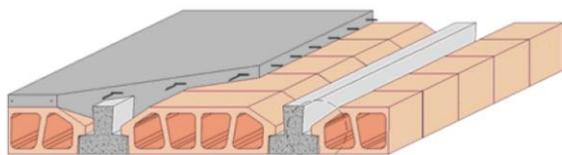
Representação esquemática de uma laje de vigotas pré-esforçadas, blocos de preenchimento e betão complementar, adaptado de Baião (2010)
